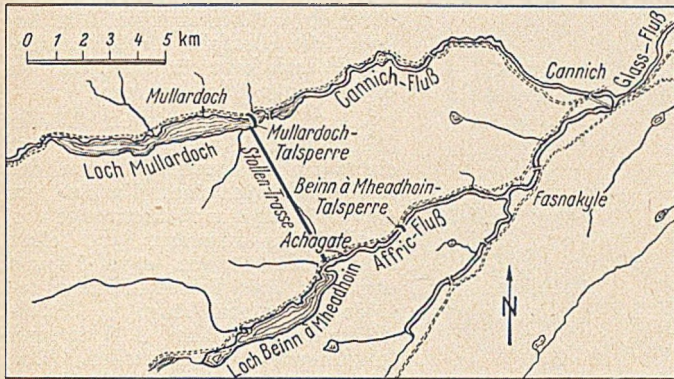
Lageplan der Kraftwerksgruppe an den Flüssen Cannich und Affric.
